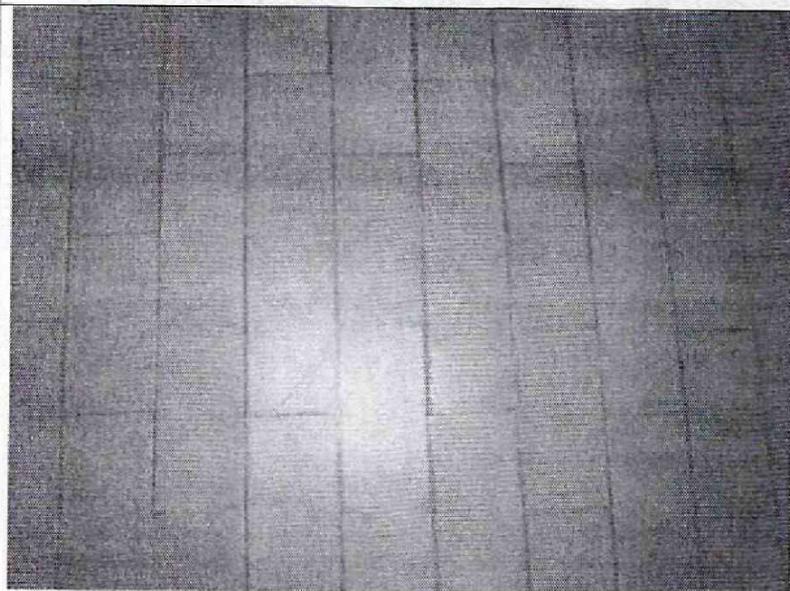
Fisuras en acabados de la placa de piso.
